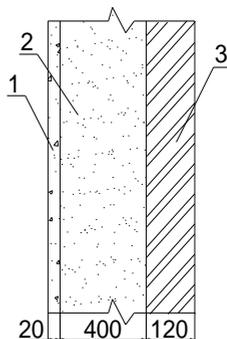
Конструкция наружной стены жилого дома:
